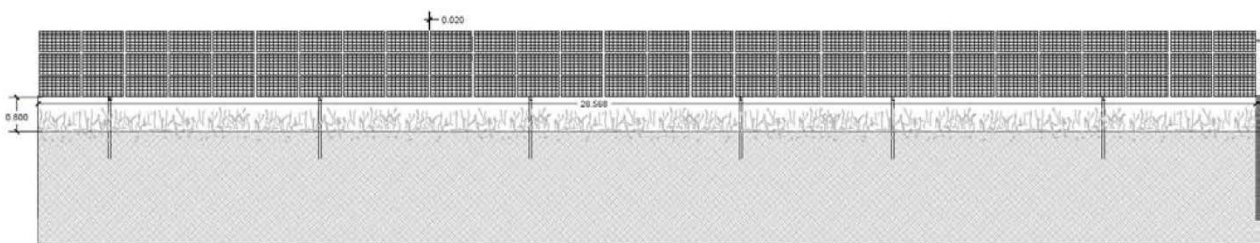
Vista frontale della struttura fissa di supporto dei moduli
